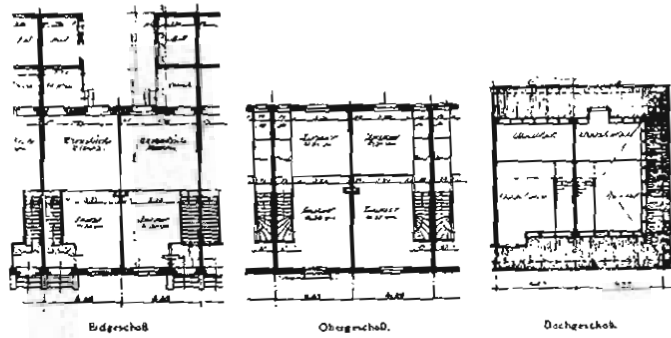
Grundrißtyp 1a (hier zweigeschossig mit ausgebautem Dach)
